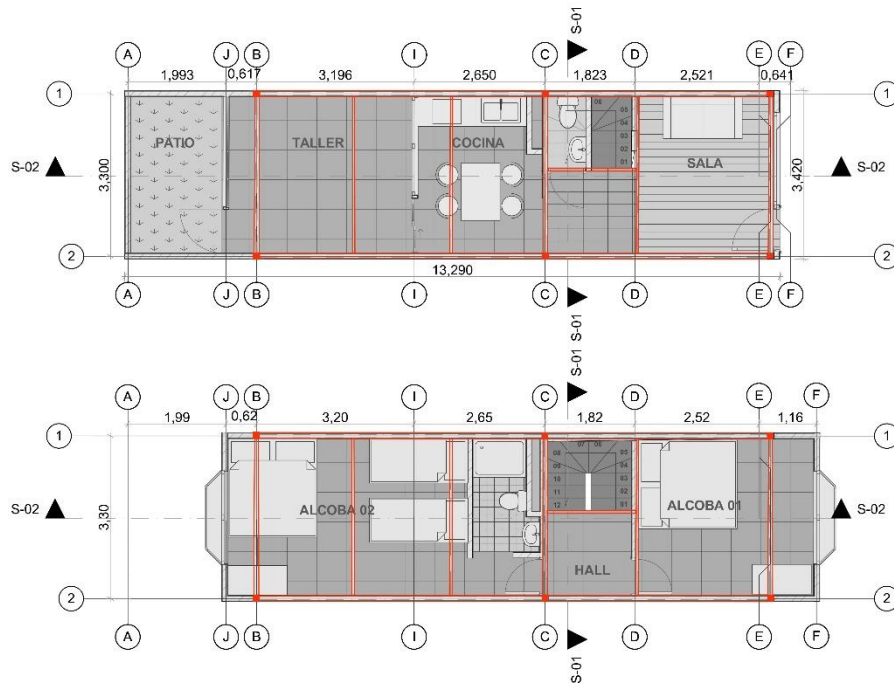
Plantas de primer y segundo piso propuesta, indicando inclusión de estructura. Elaboración propia 2017.
